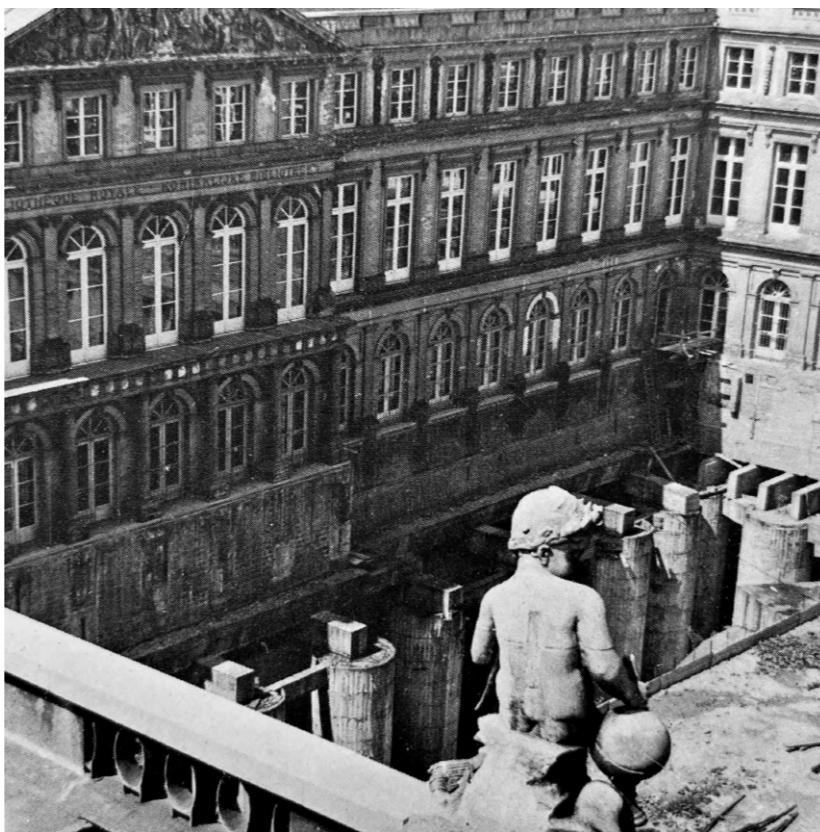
Vue sur les faux puits en béton de long de la façade
